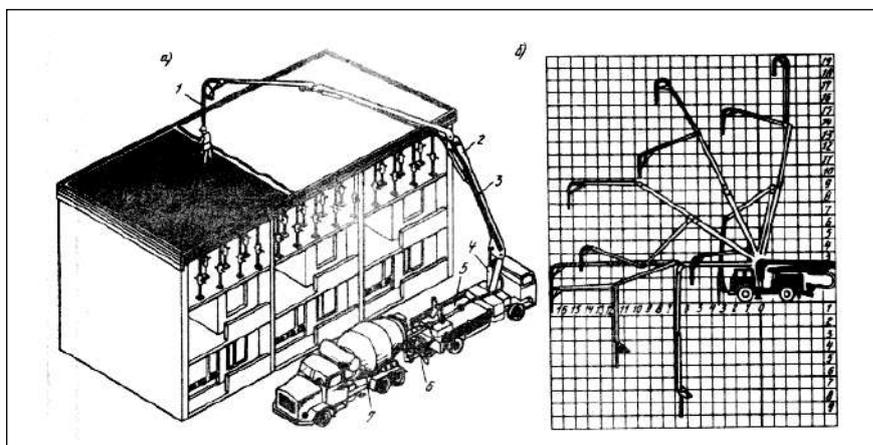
Подача бетонной смеси автобетононасосом:
